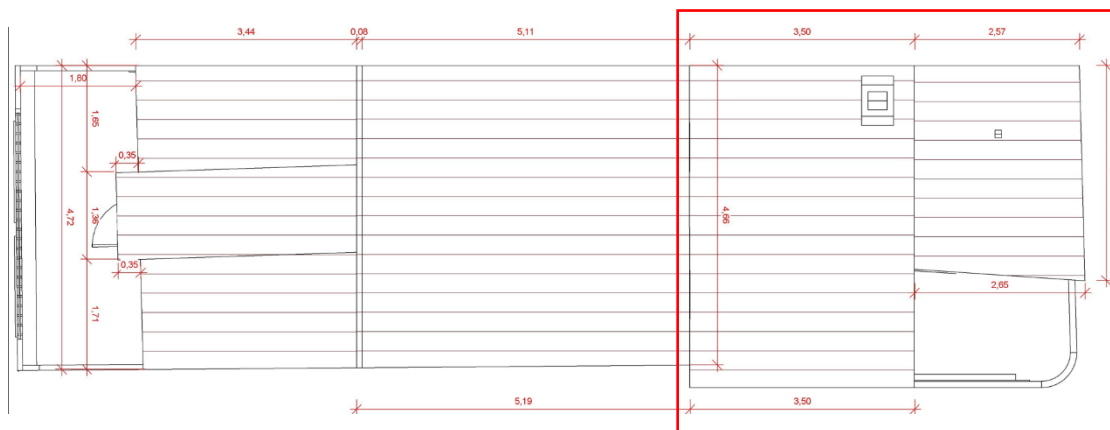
Planta da cobertura com destaque na estrutura colapsada
